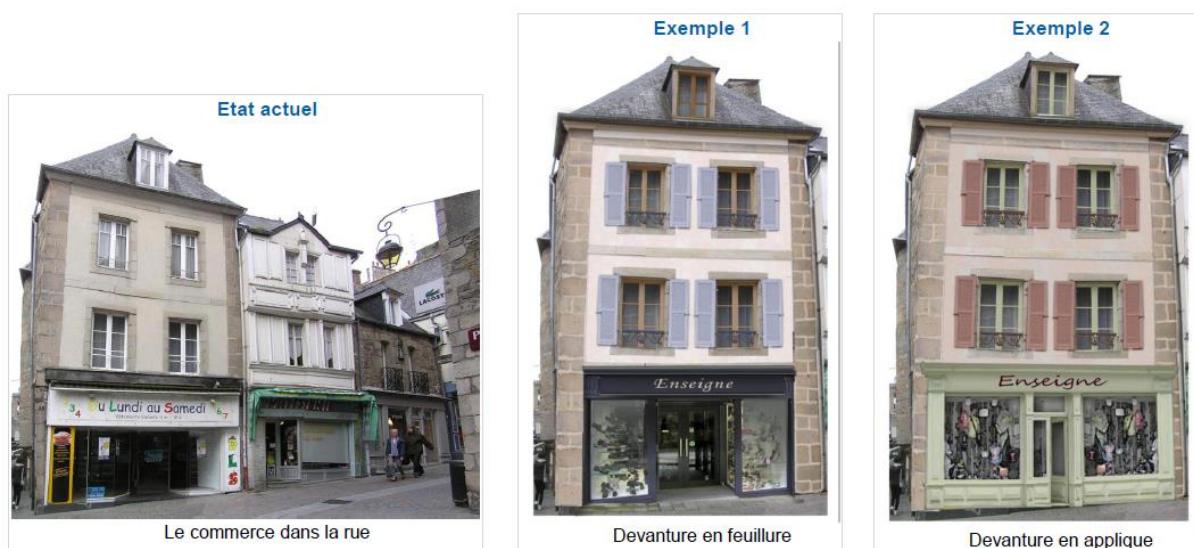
Exemple de valorisation de façade dans le cadre d'une charte architecturale et de coloration des façades
